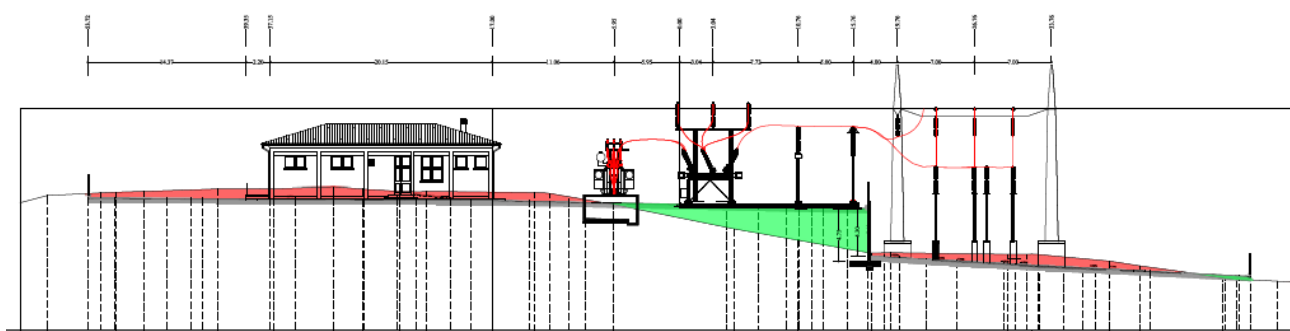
sezione longitudinale della cabina primaria in progetto
